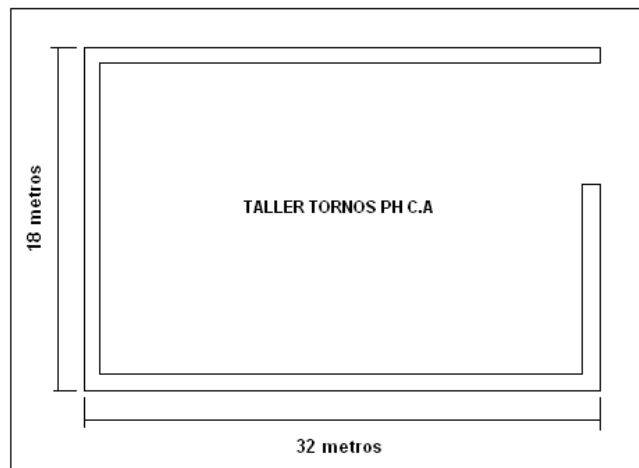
Dimensiones de Taller Tornos PH C.A. Fuente propia
